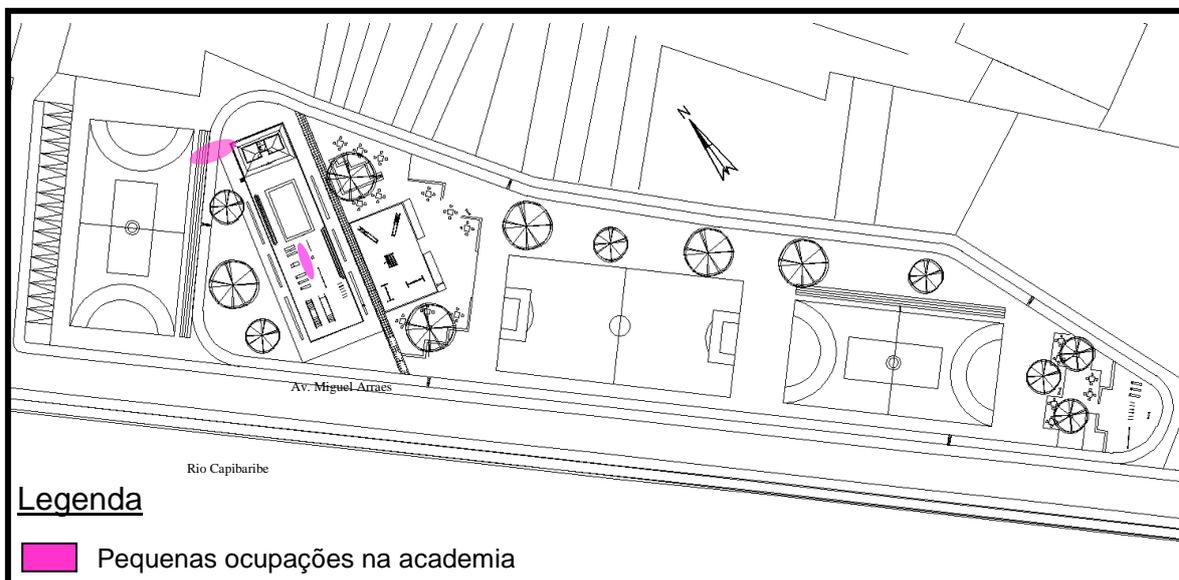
Planta Baixa da Academia da Cidade de Paudalho.
